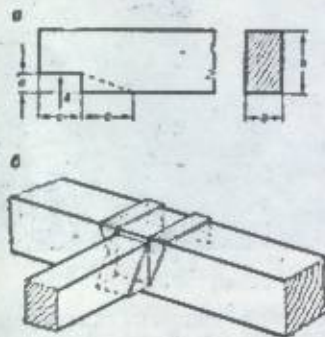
Опирание деревянных балок: а — подрезка на опорах; б — опирание балок с помощью металлических хомутов.
